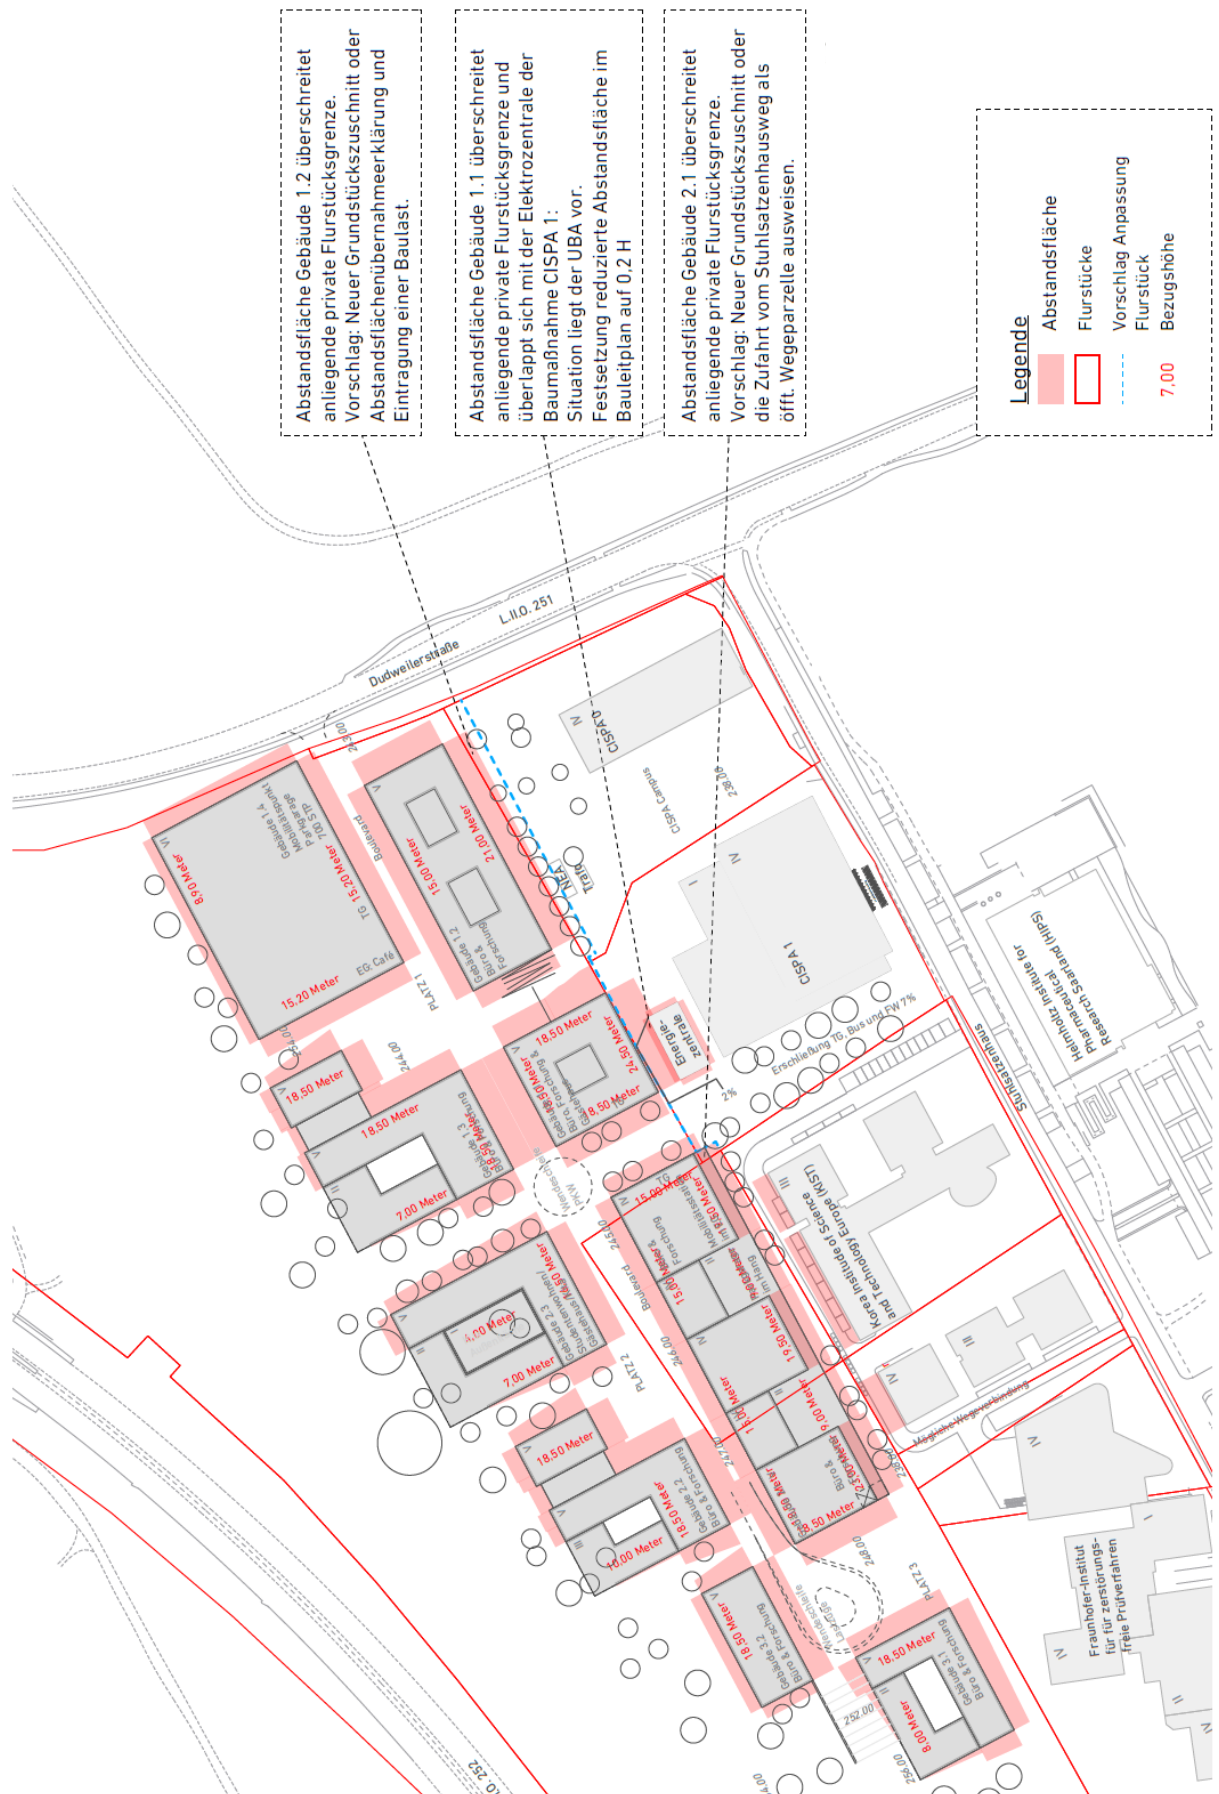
Rahmenplan „Nördlich Stuhlsatzenhaus“ – Abstandsflächenplan
